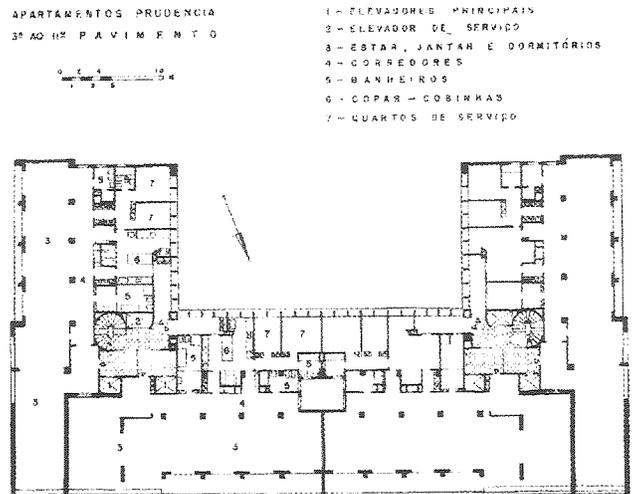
Edifício Prudência de Rino Levi, 1948, São Paulo. Planta do pavimento tipo.
